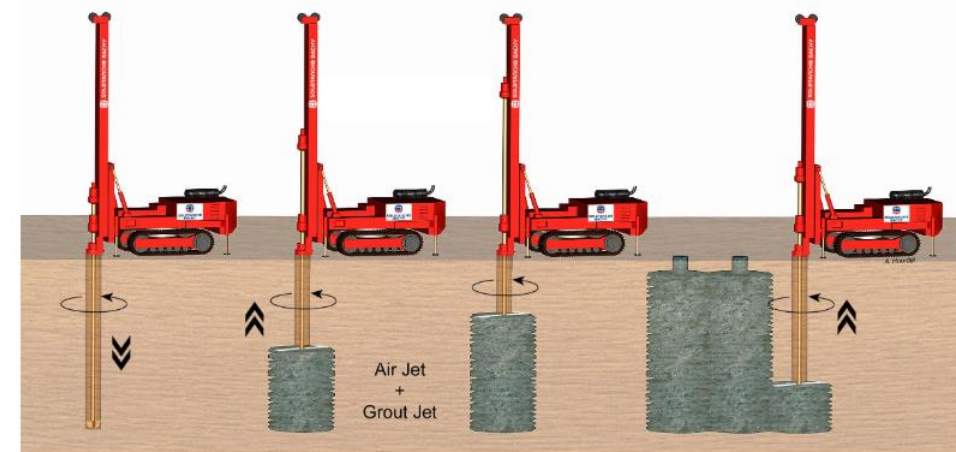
Principe de réalisation du traitement par jet grouting (Source : Soletanche Bachy)
